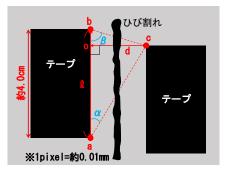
ひび割れ撮影時の画像のイメージ図
